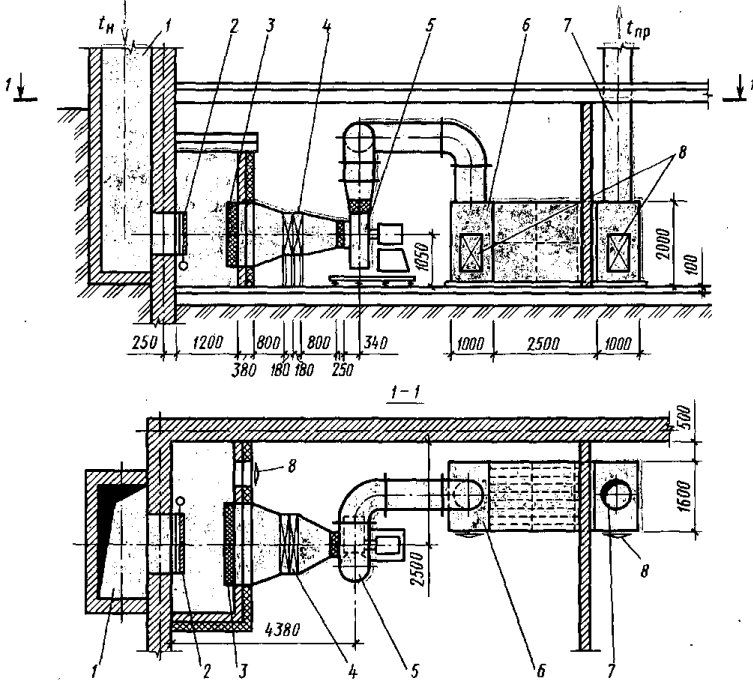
Камера приточной установки: а, б – разрез и план; 1 – воздухозаборное устройство; 2 – утепленный клапан, заслонка; 3 – воздушные фильтры; 4 – калориферы; 5 – вентиляционный агрегат; 6 – шумоглушитель; 7 – приточный воздуховод; 8 – люк; 9 – гибкая вставка; 10 – конфузор; 11 – приемная камера; 12 – диффузор
